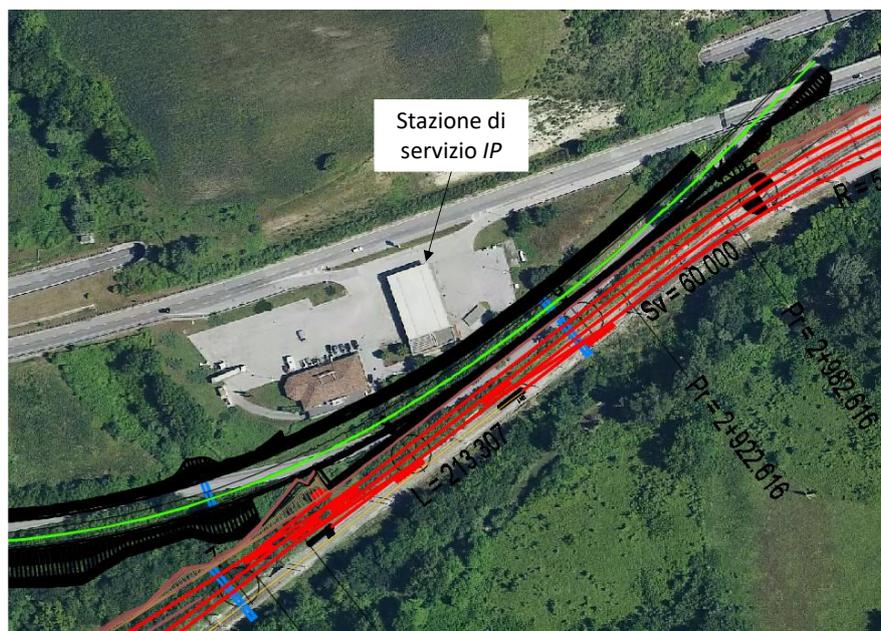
Stazione di servizio IP e tratta ferroviaria di progetto (in rosso); in verde la viabilità di progetto
